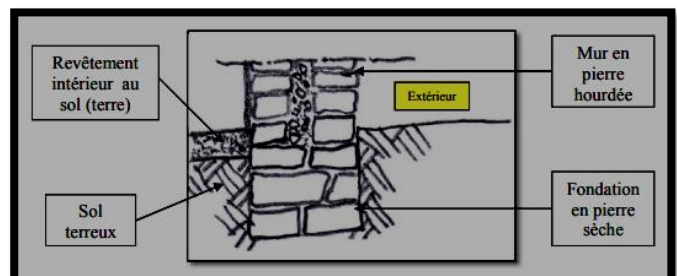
Fondation fondation en pierres sèches, en tranchée superficielle. Source: L. Abdelouahab (2016)
